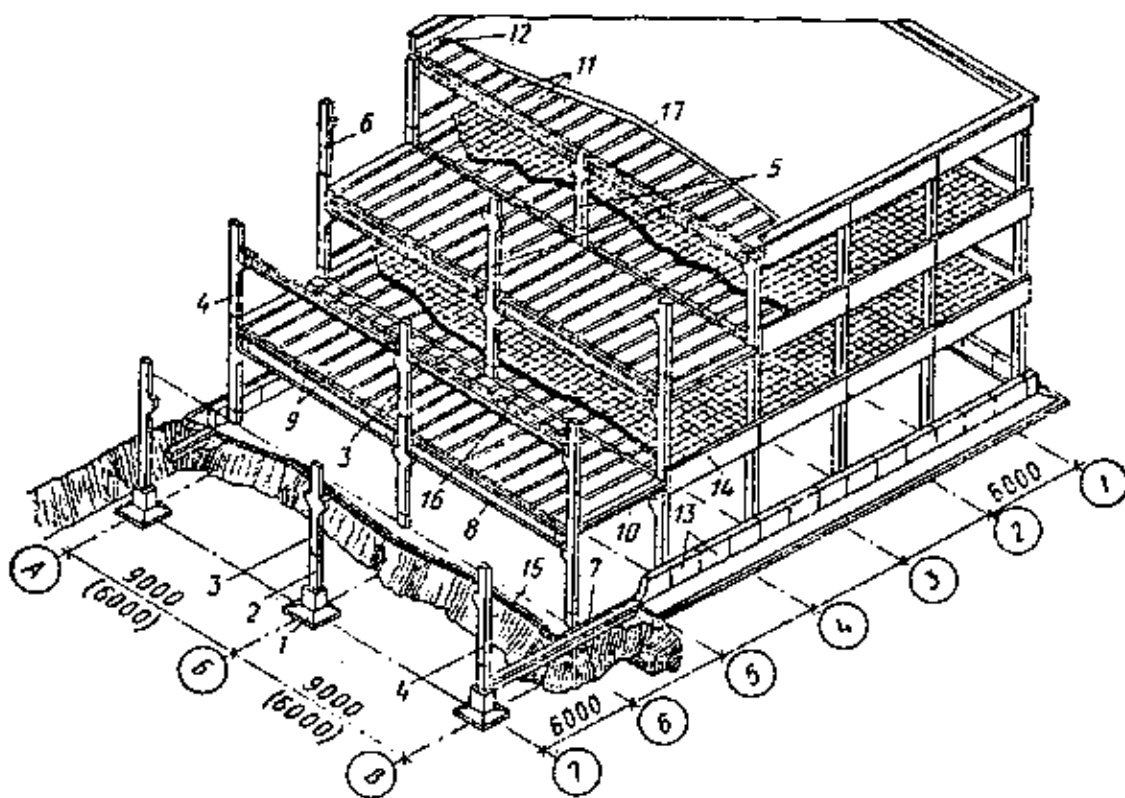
Багатоповерхова виробнича будівля з балковими перекриттями:
